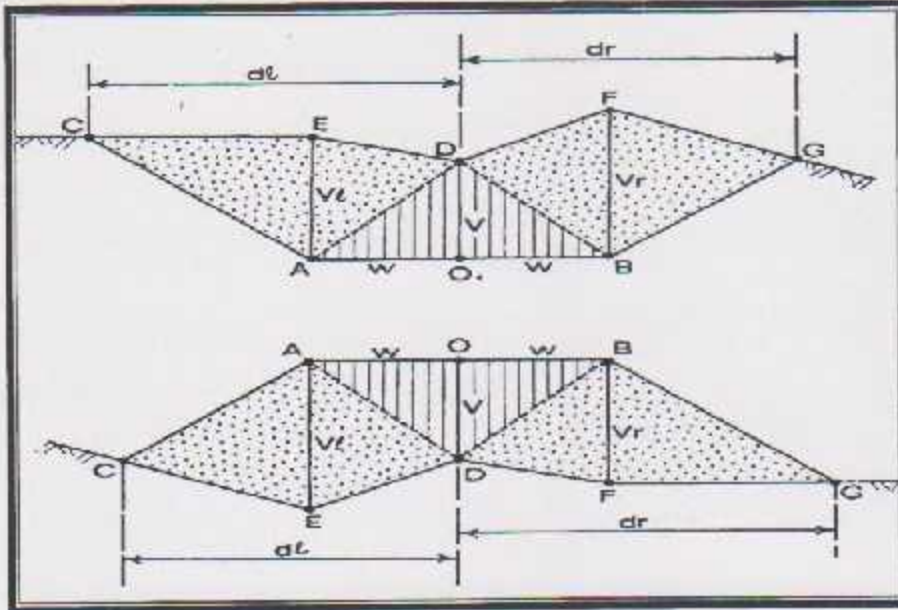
مقطع عرضي من ثلاث نقاط.
